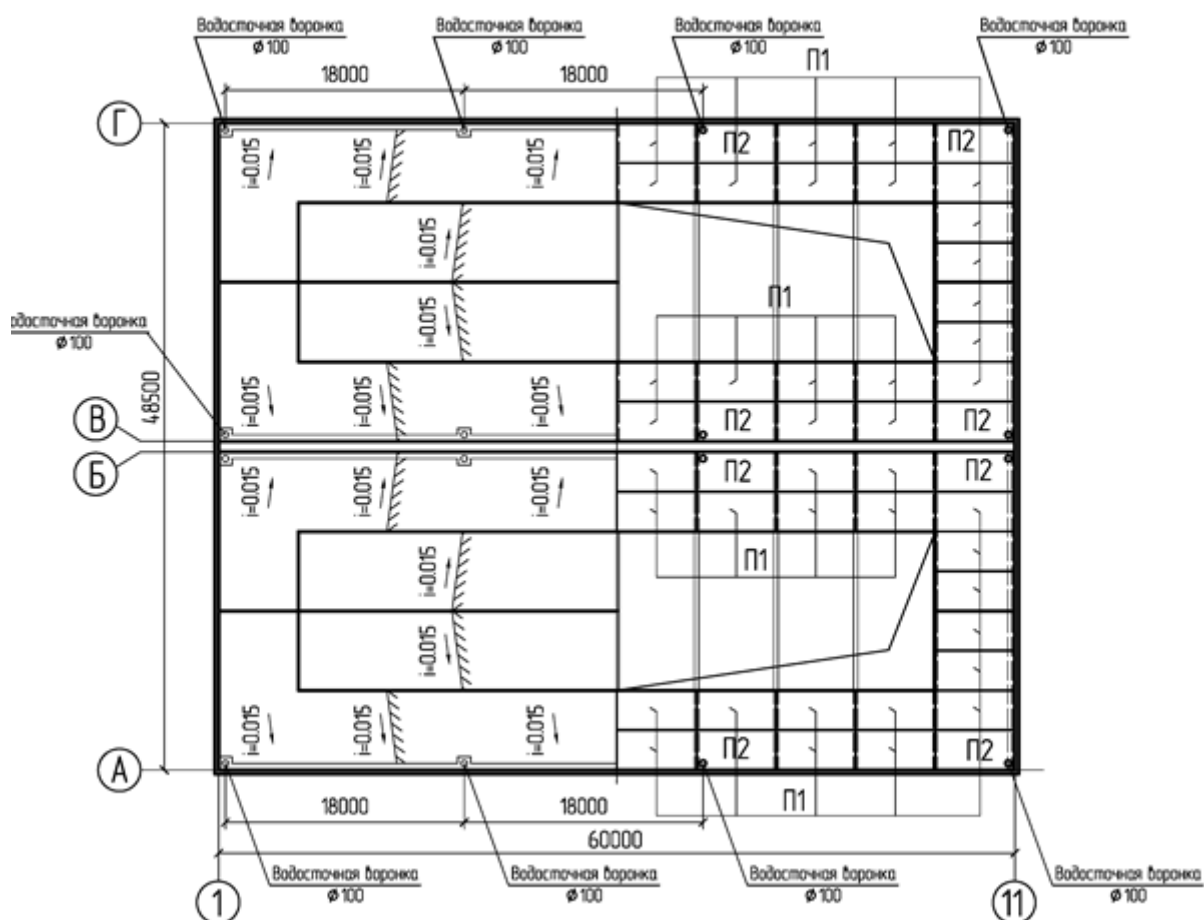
Пример совмещённого плана покрытия и плана кровли.
